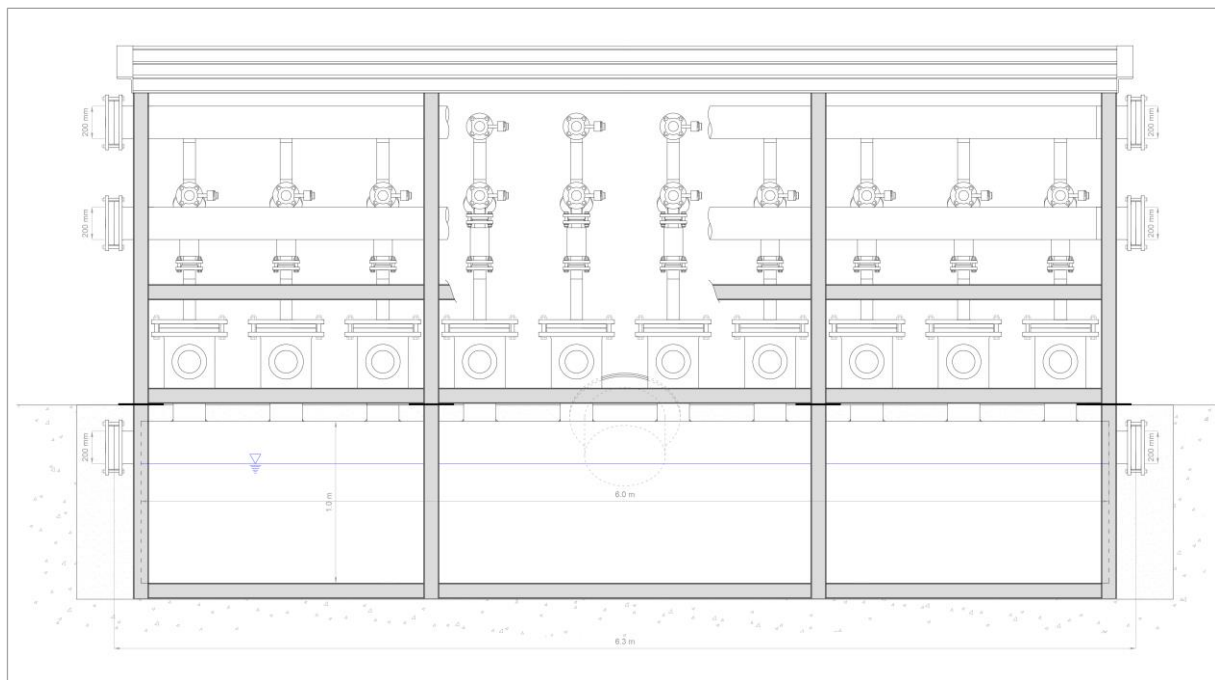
53 – Planimetria con disposizione dei manufatti di captazione del biogas dei moduli superiori
